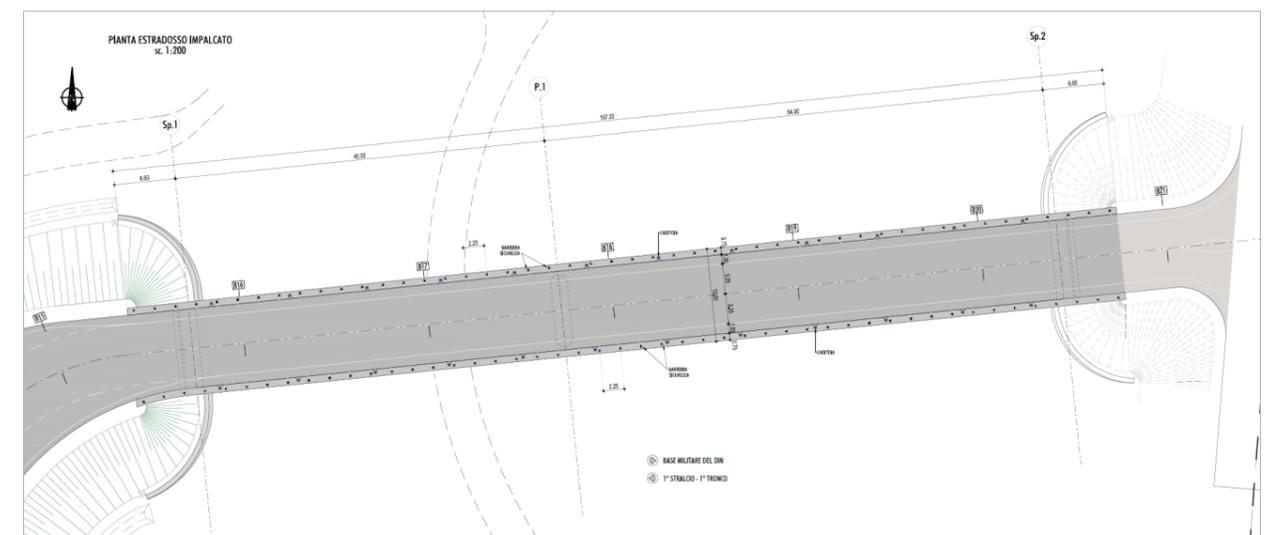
VISTA IN PIANTA DEL PONTE – LIVELLO IMPALCATO
